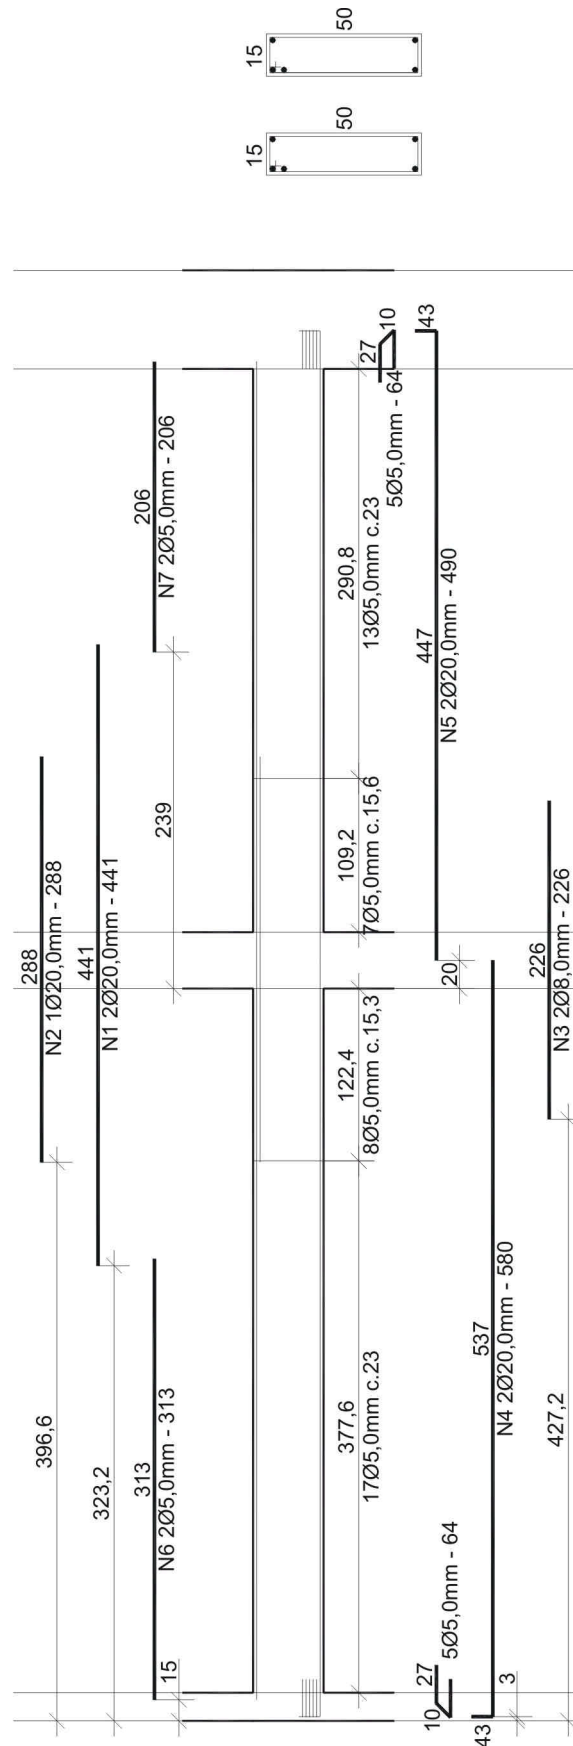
Detalhamento Viga 03.2, realizado pelo VigaCalc.
